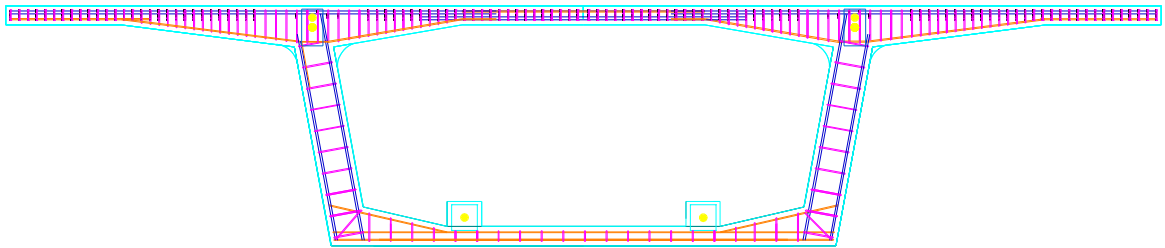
Diseño de armado de hierros y ductos de pretensado de las dovelas de 2.8 m. de peralte
